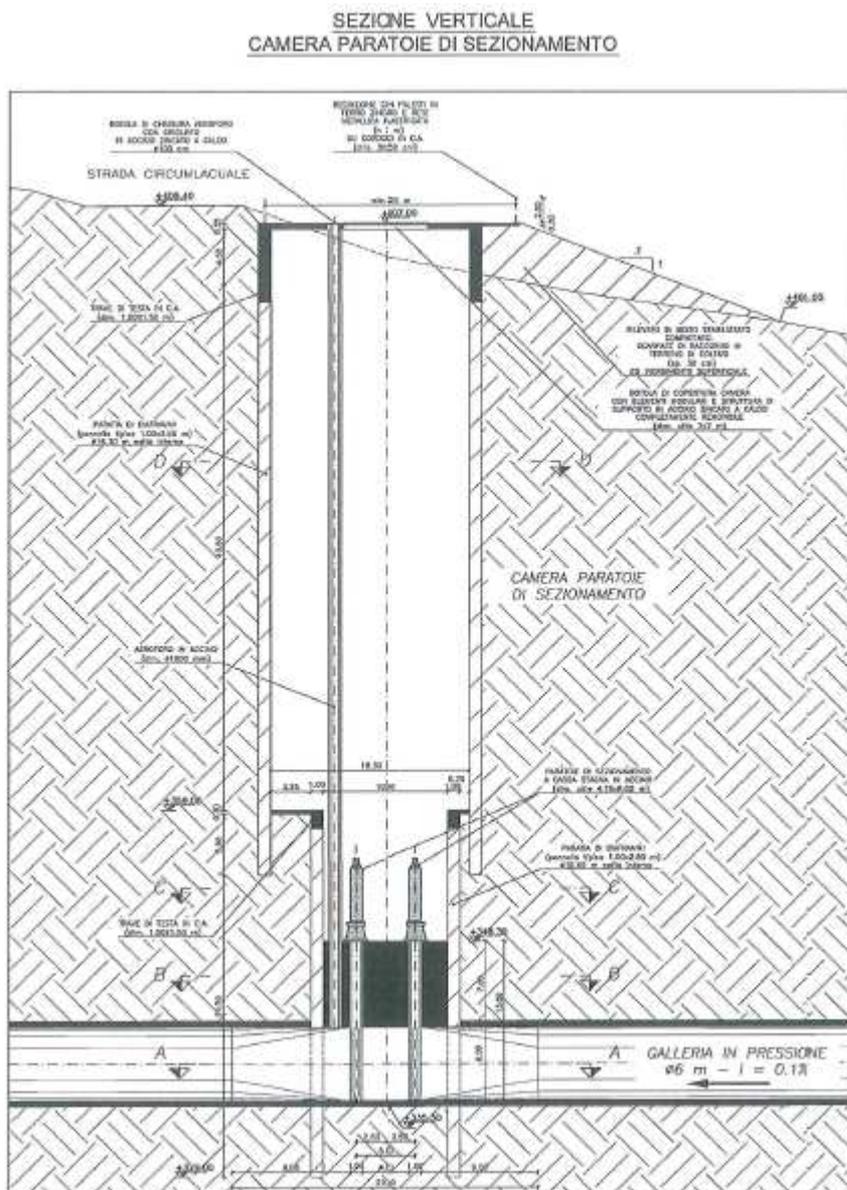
Camera paratoie di sezionamento, sezione verticale.
